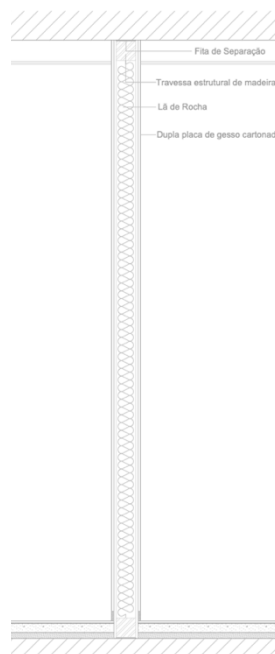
Corte da parede com sistema PLADUR (sem escala) (Fonte Própria)
